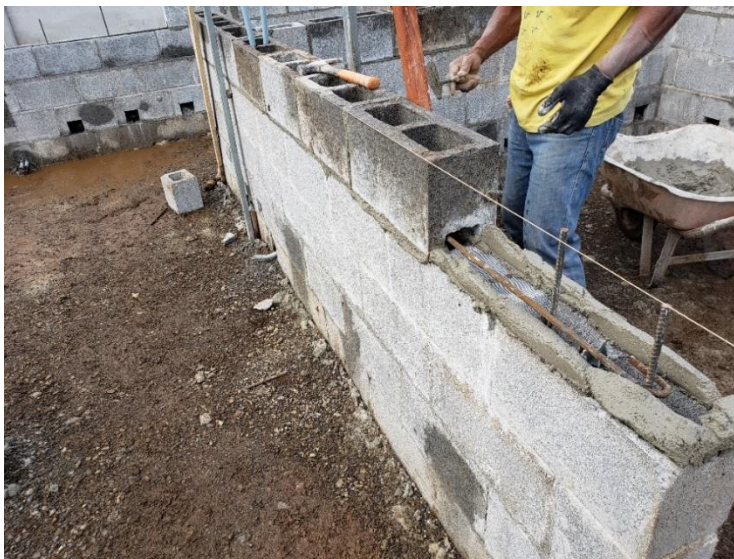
Colocación de bloques de mampostería en Proyecto Vargas Jarquín.
